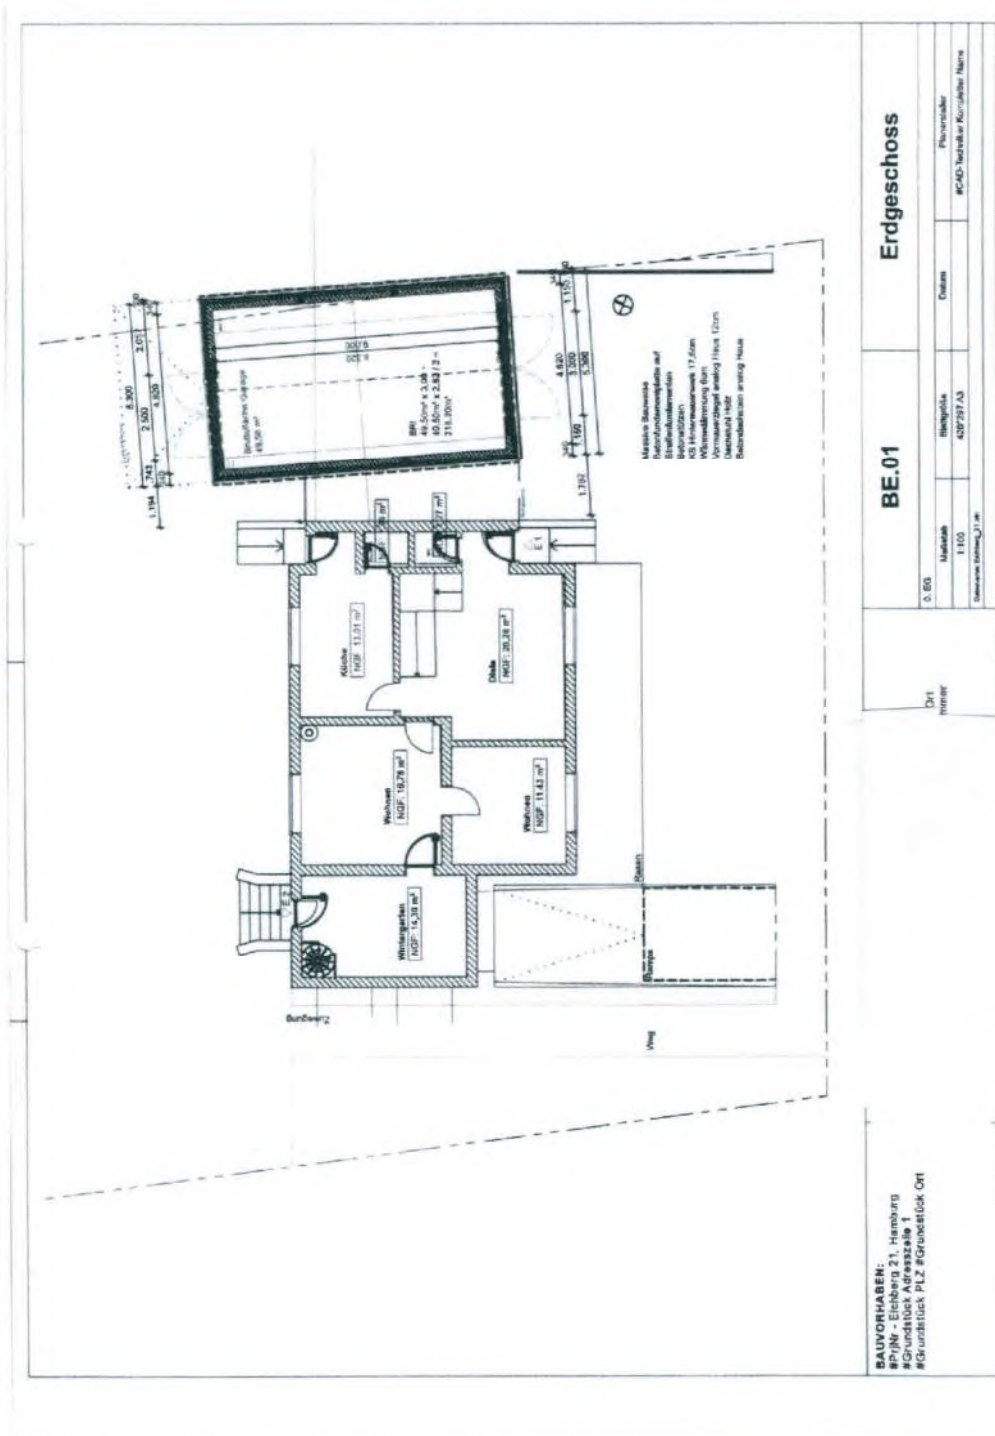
Grundriss EG mit Garagengebäude 2011
